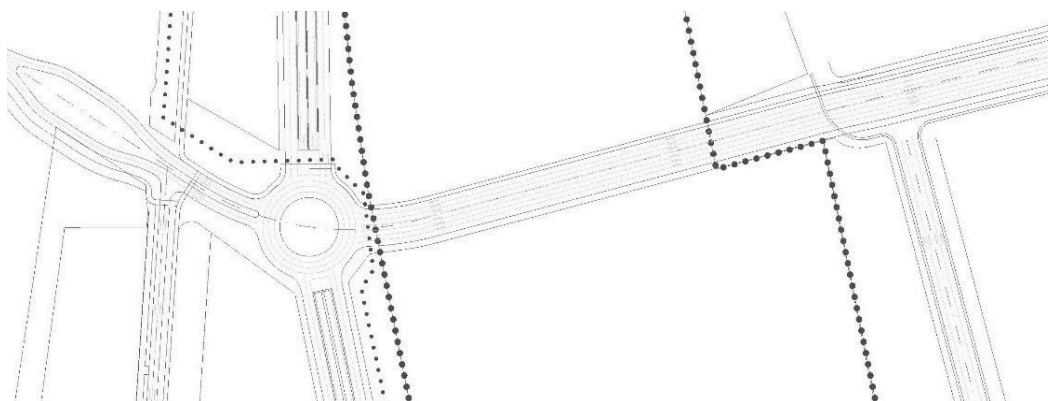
Planta de Puente de Santo Domingo de la Calzada.
